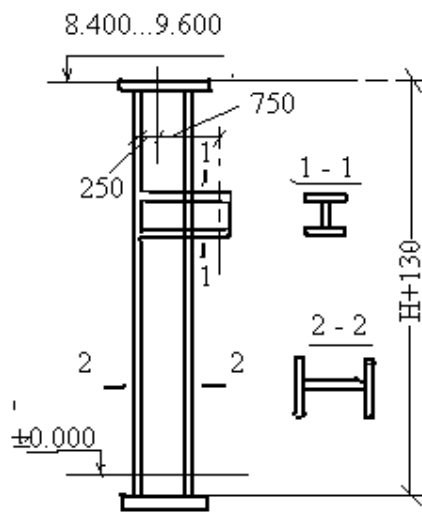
Крайняя сплошная стальная колонна для зданий с мостовым краном
